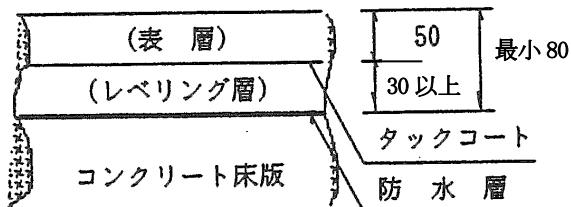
コンクリート床版（PC床版を含む）上の舗装施工例（単位：mm）
